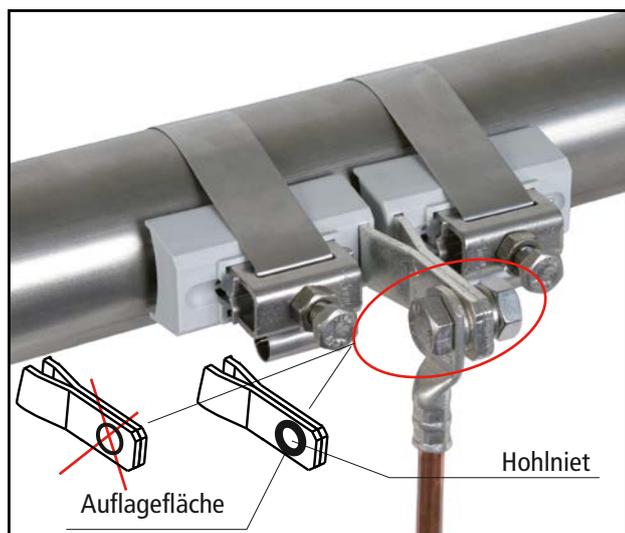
a Kabelschuh z.B. für Rundleiter
